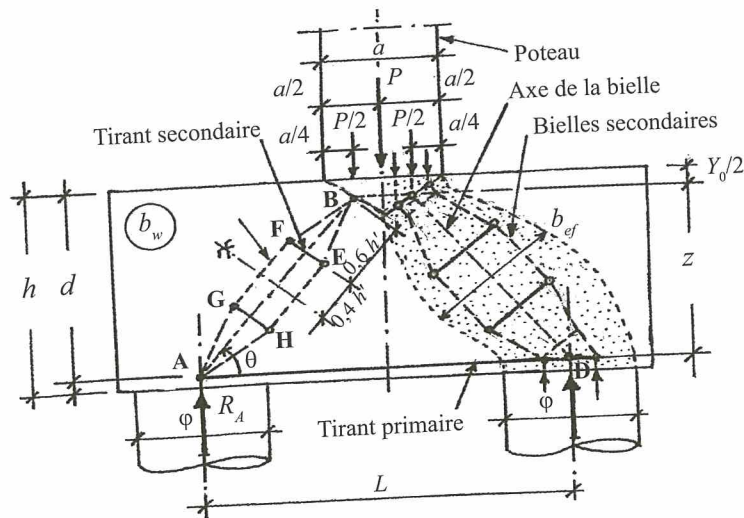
Modélisation B-T (affinée) pour une semelle sur deux pieux sous poteau en compression centrée.
